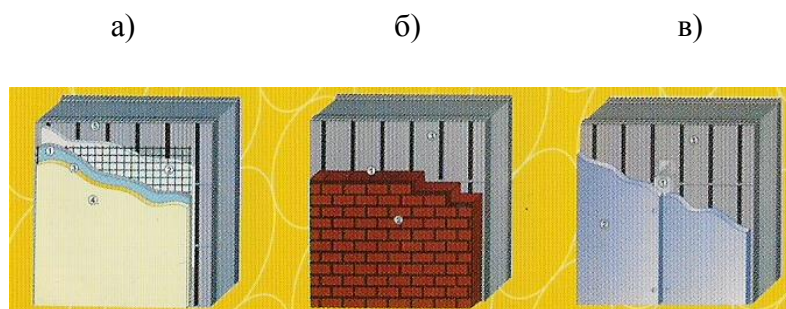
Варианты наружной отделки стен из несъемной пенополистирольной опалубки
